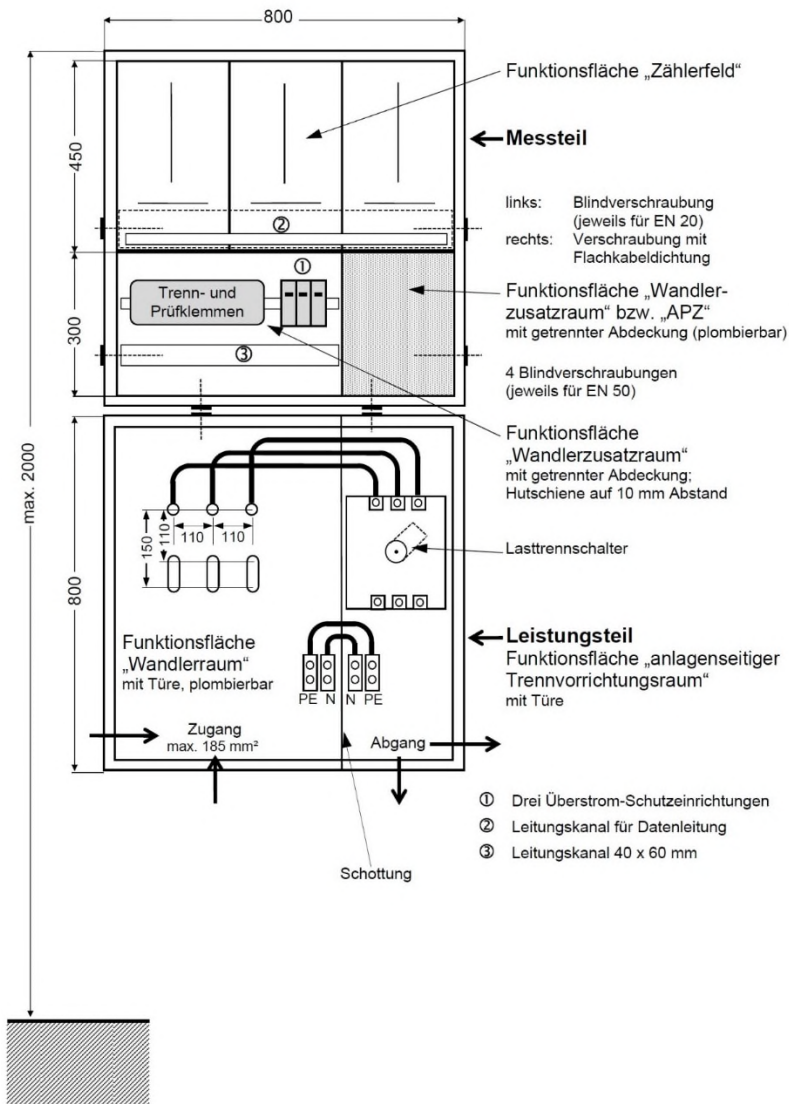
Prinzipieller Aufbau einer halbindirekten Messung (Wandlerraum) bis 250 A
